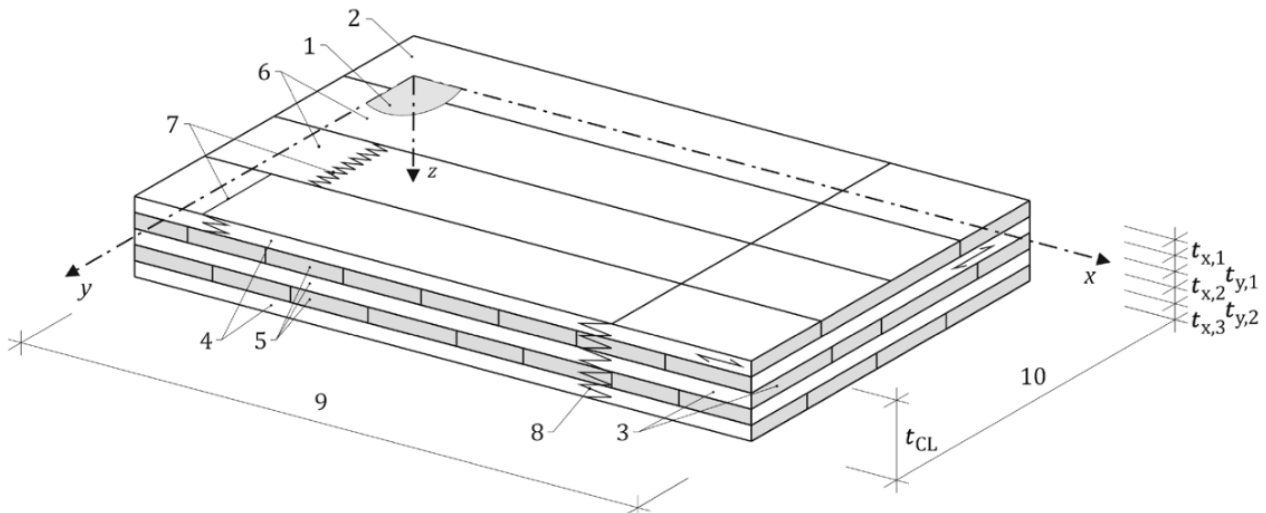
Aufbau von Brettsperrholz (Explosionszeichnung), aus [29]
